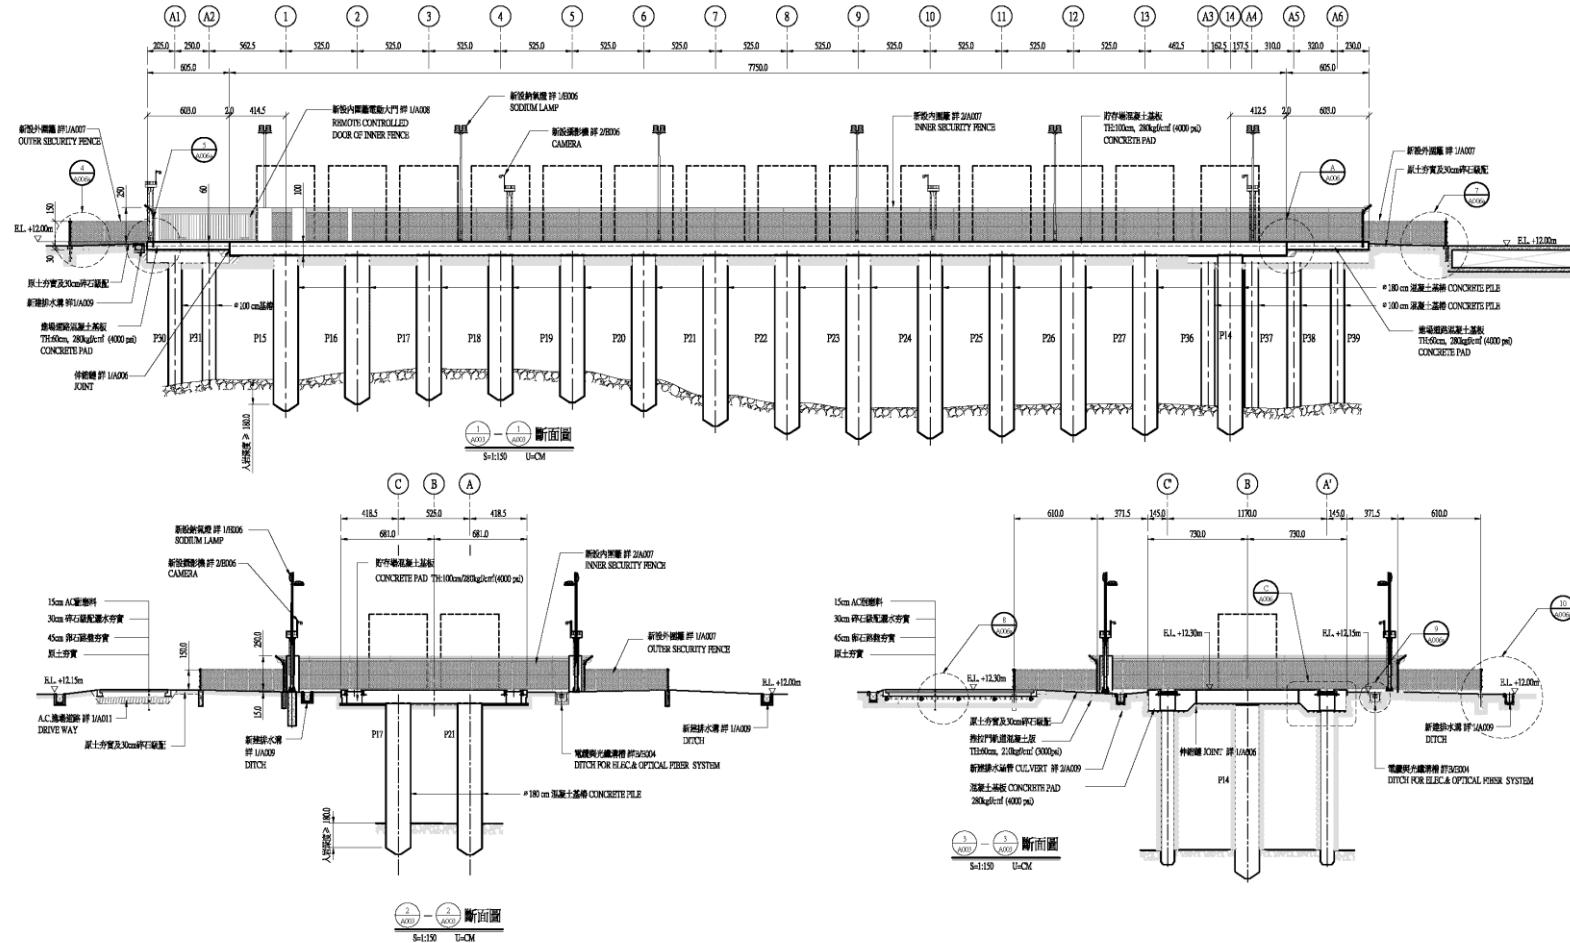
貯存場混凝土基座全區剖立面圖
